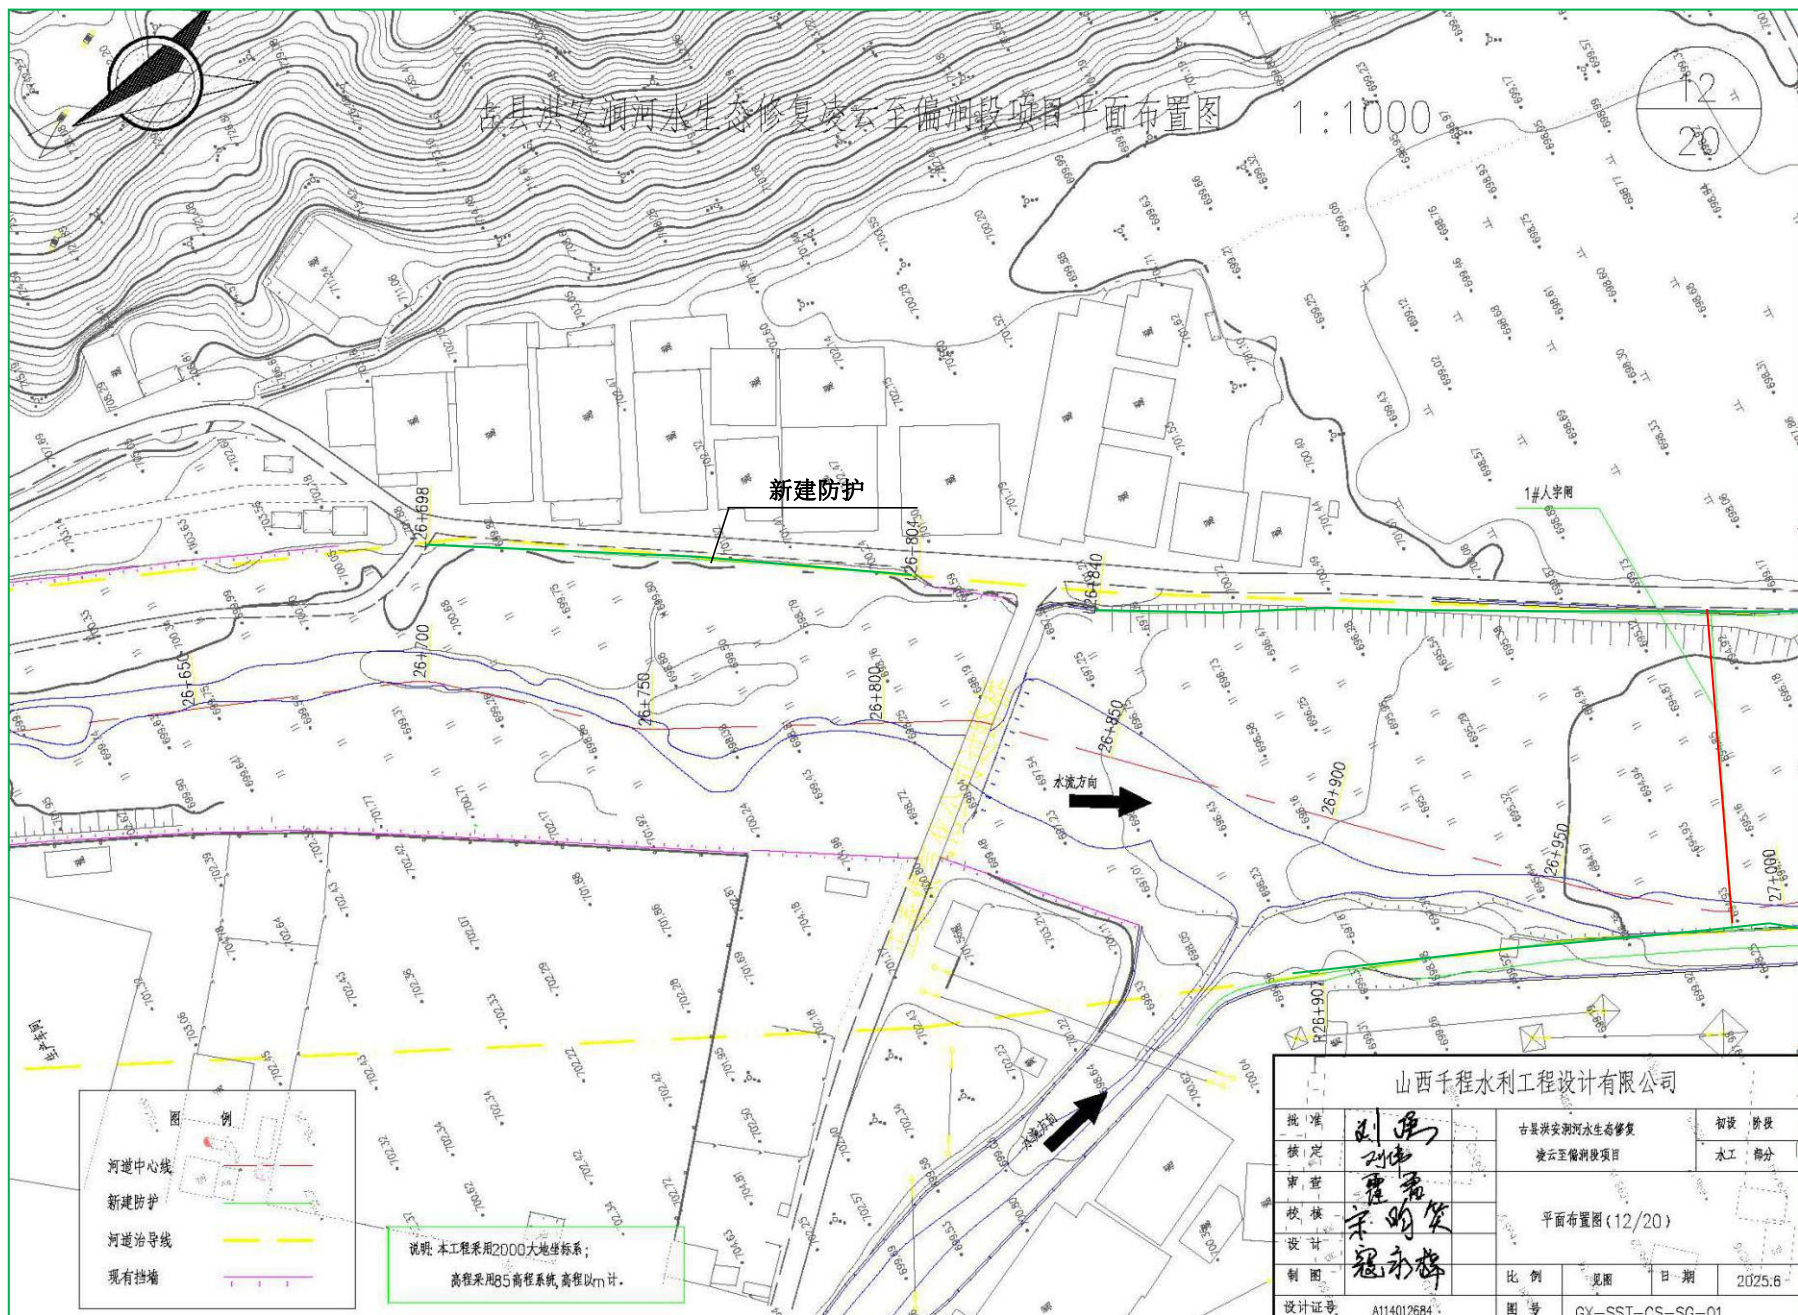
(12) 工程总平面布置图 (桩号 26+600-27+000)
